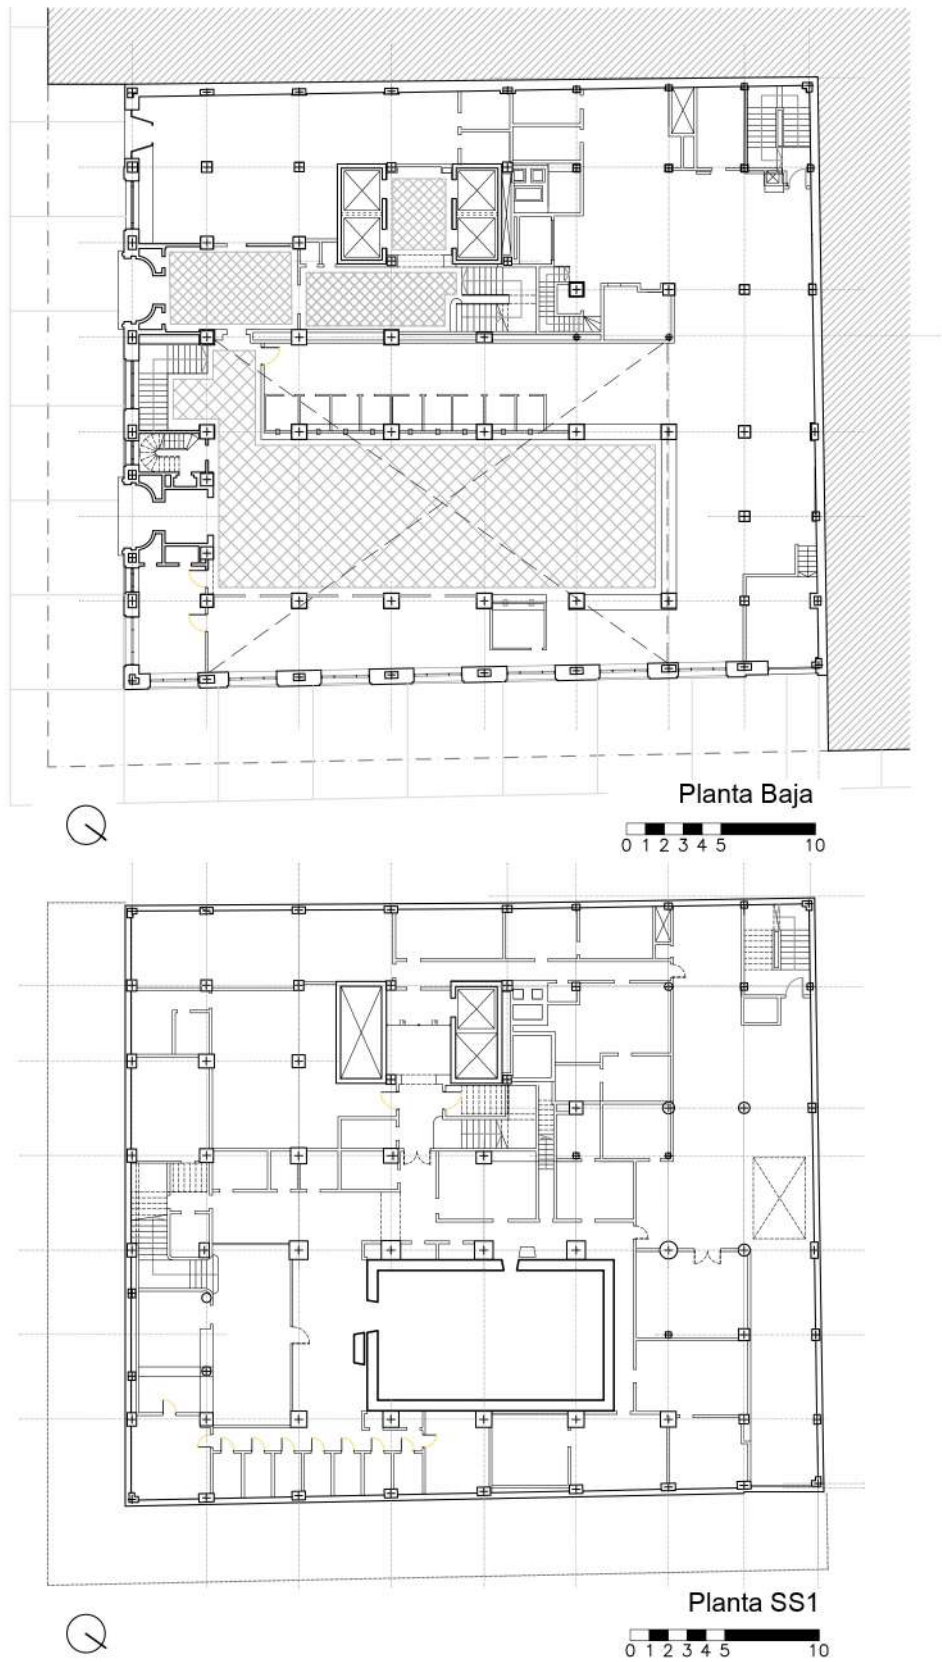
Estructuras de subsuelo y planta baja del Edificio Artigas, con el hiato de la bóveda. IYP, 2019.
